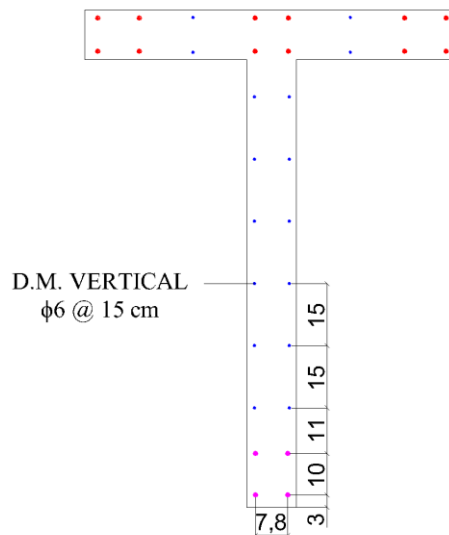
Plano (con vista en elevación) del muro de ensayo ET2.
